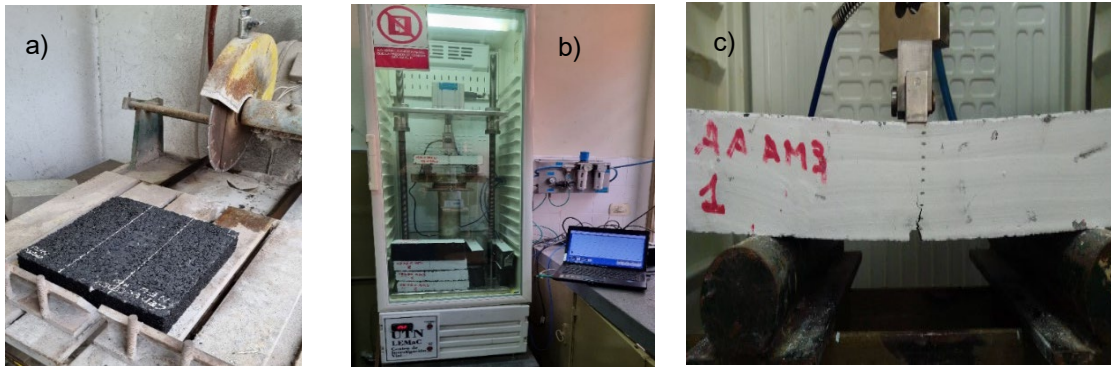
Ensayo a propagación de fisuras en probetas previas. a) Corte de probetas rectangulares. b) Equipo de ensayo. c) Ensayo en proceso. (Fuente propia)
